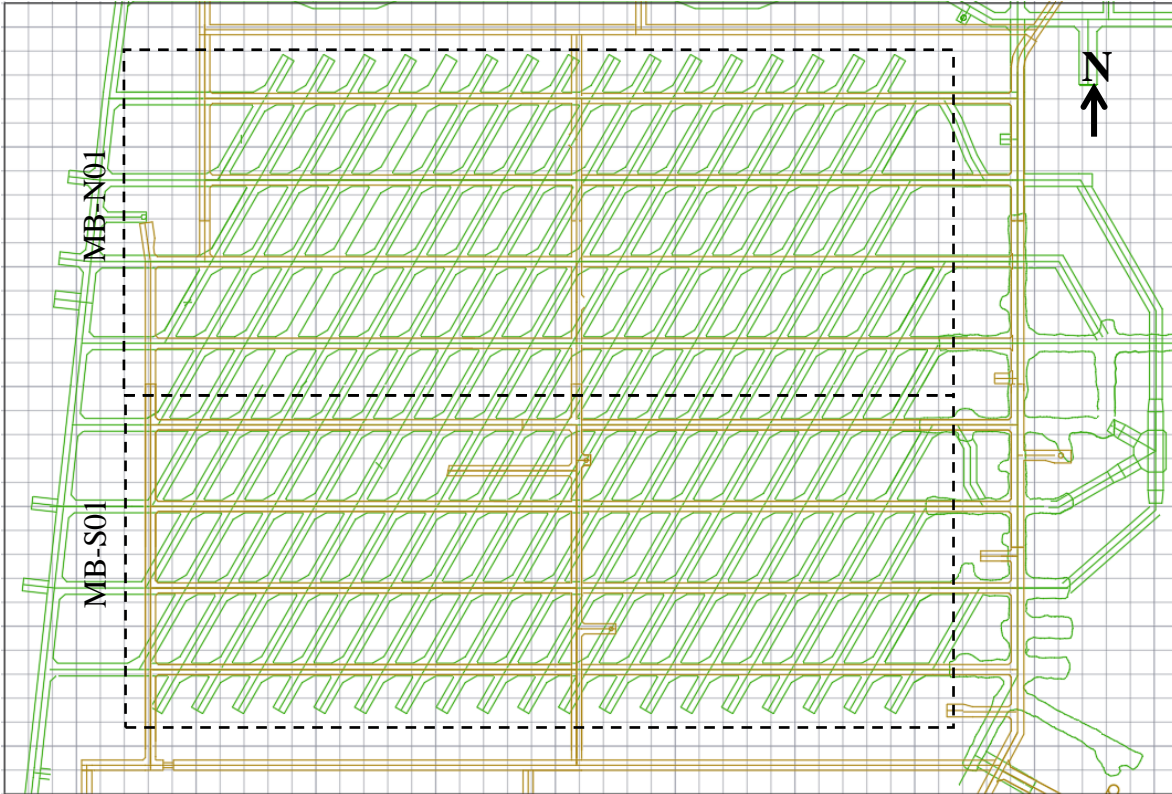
Vista en planta superposición NH con NP para MB N01 y S01
